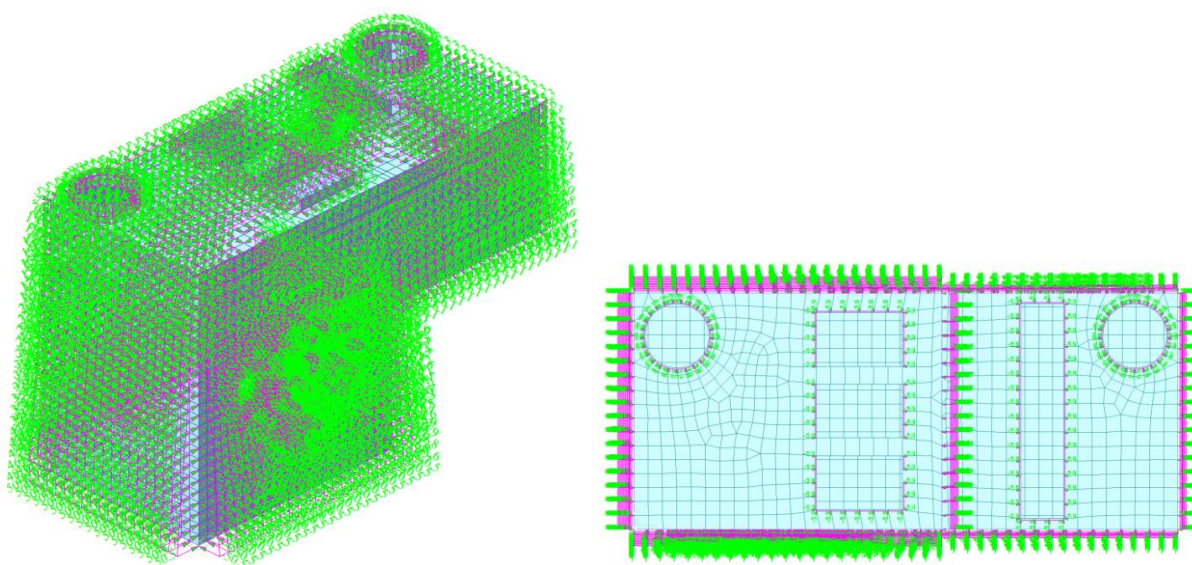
Spinta terra a riposo, cameretta di sollevamento.
